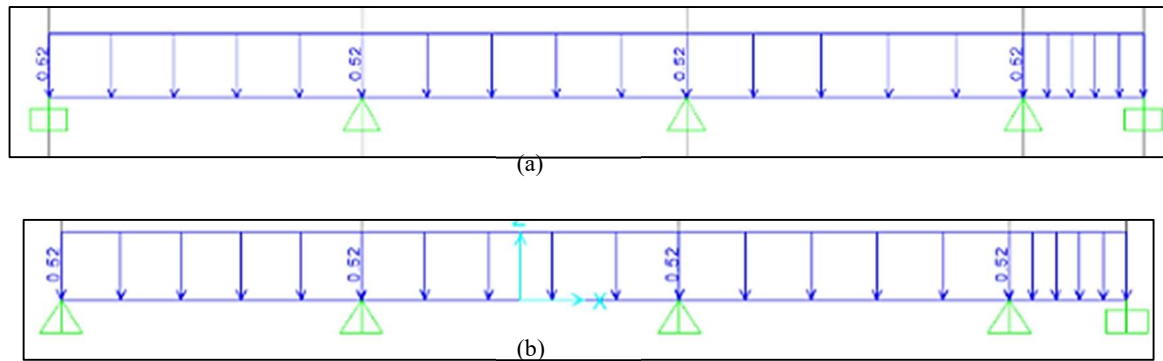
Modelos estructurales: (a) vigueta tipo 1, y (b) vigueta tipo 2
